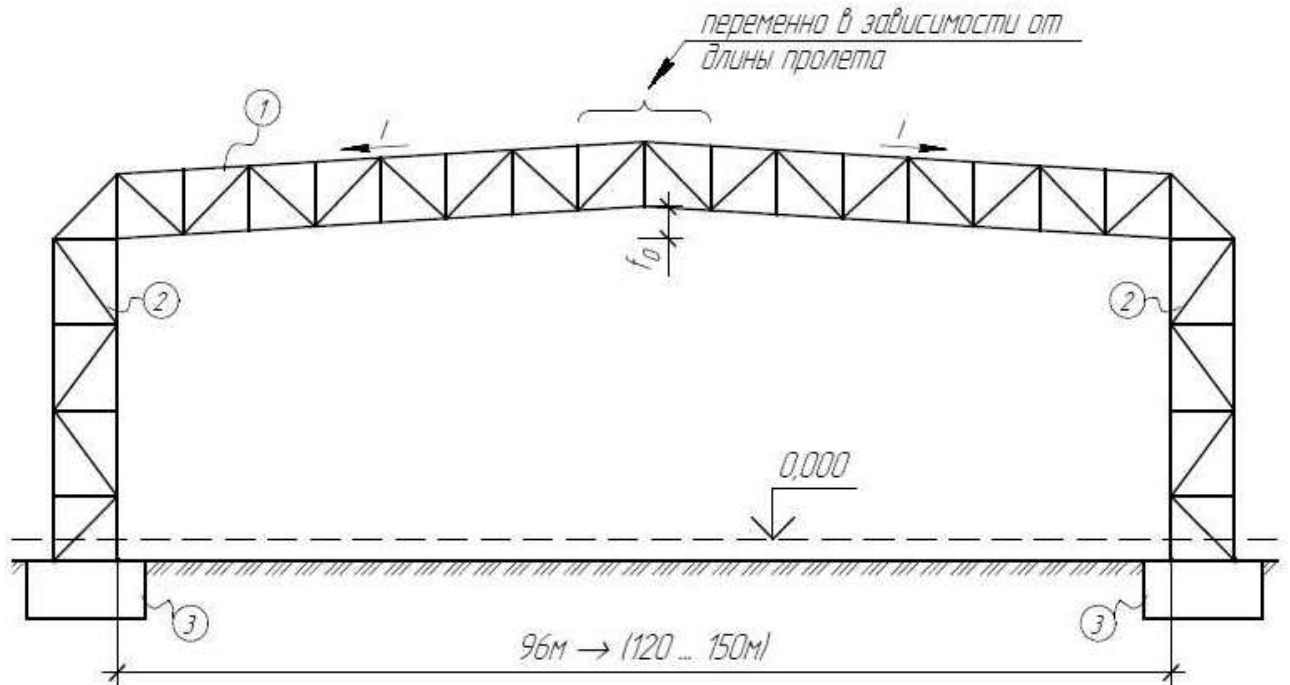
Бесшарнирная большепролетная рама со сквозными ригелями и колоннами с отдельными базами: 1 – ригель; 2 – колонны; 3 – фундаменты; 0,000 – отметка чистого пола;  $f_0$  – начальный строительный подъем
